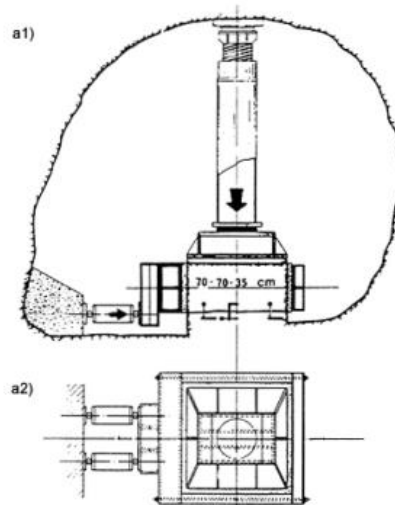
Esquema do ensaio de deslizamento, a1) vista em corte; a2) vista em planta [9]
